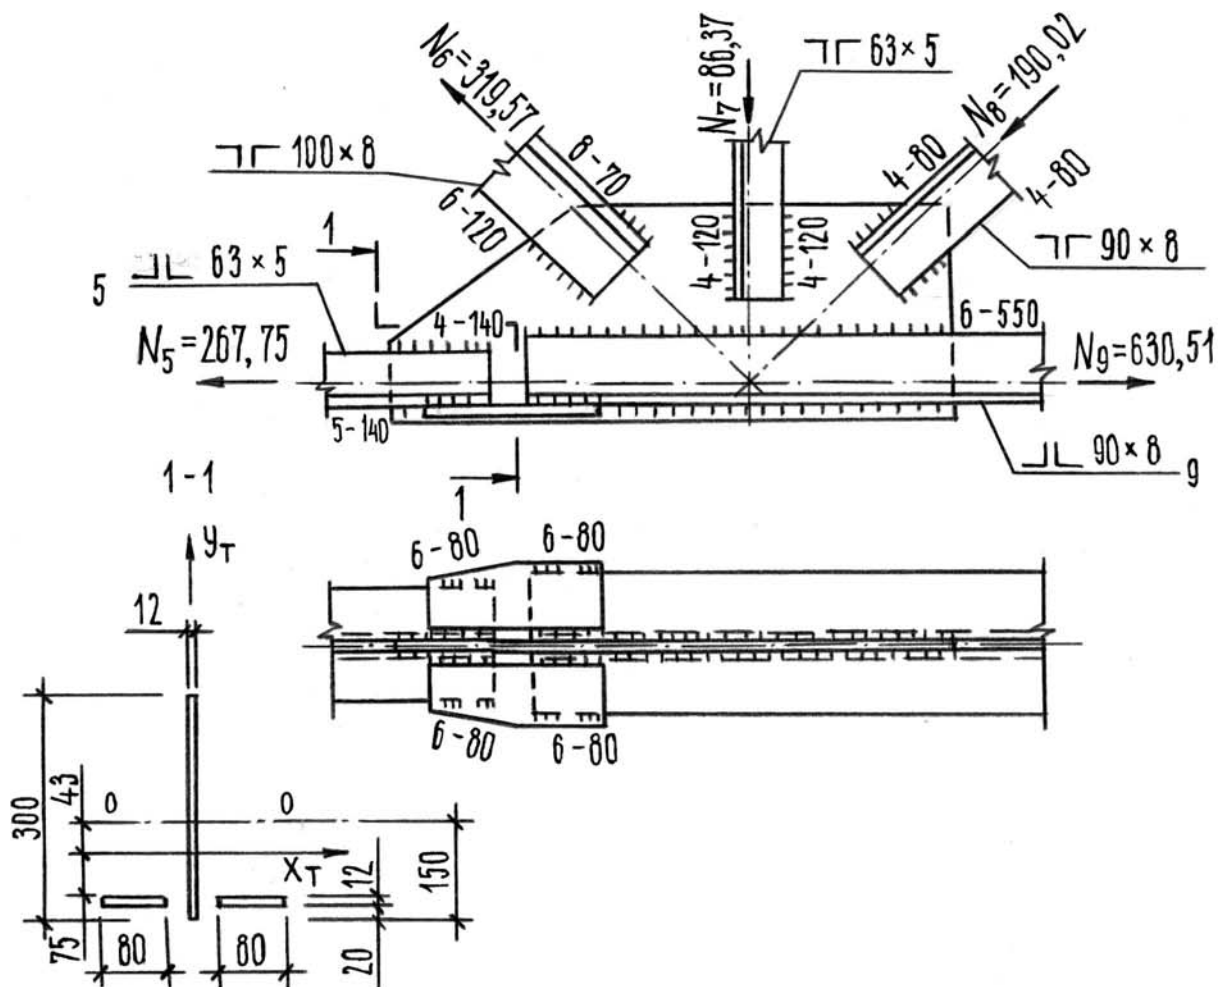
Узел стыка нижнего пояса фермы (пример 2)
